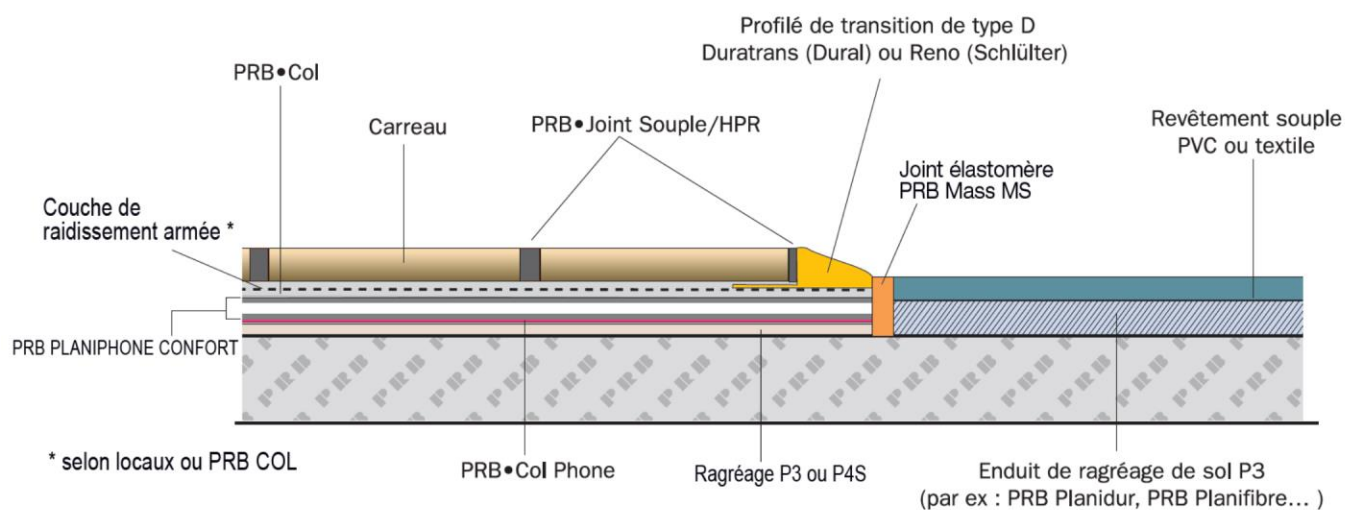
Traitement d'un raccord entre le système PRB PLANIPHONE CONFORT et un revêtement de sol souple
